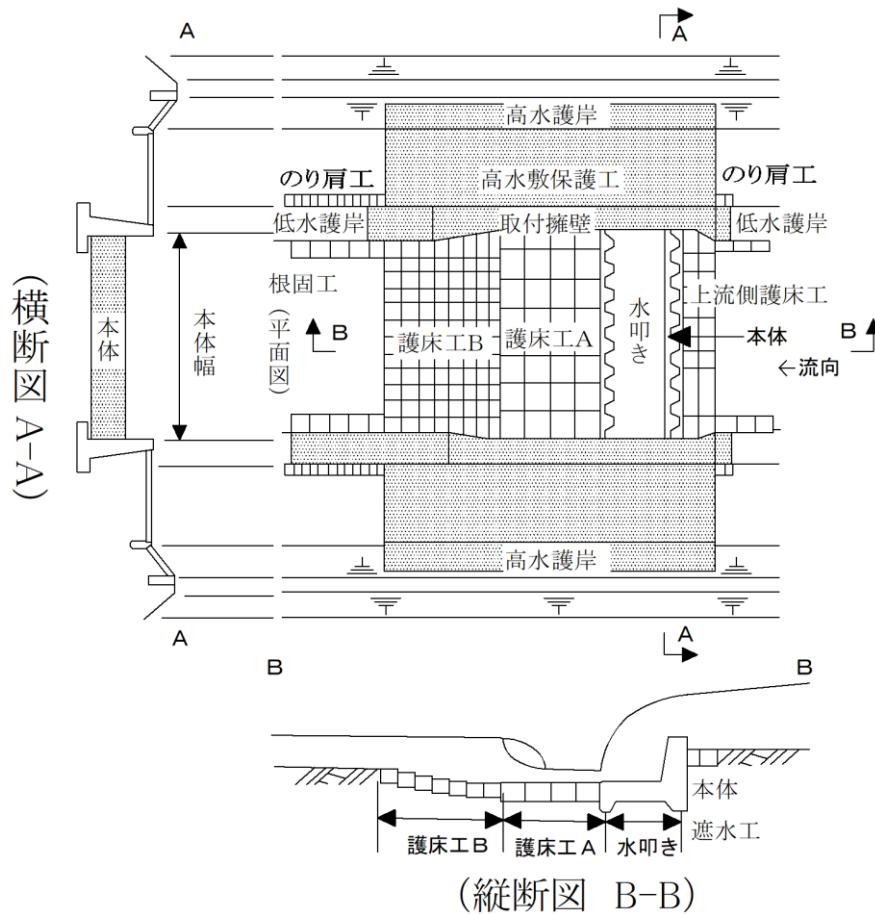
床止めの各部位の名称（コンクリート構造の場合）
